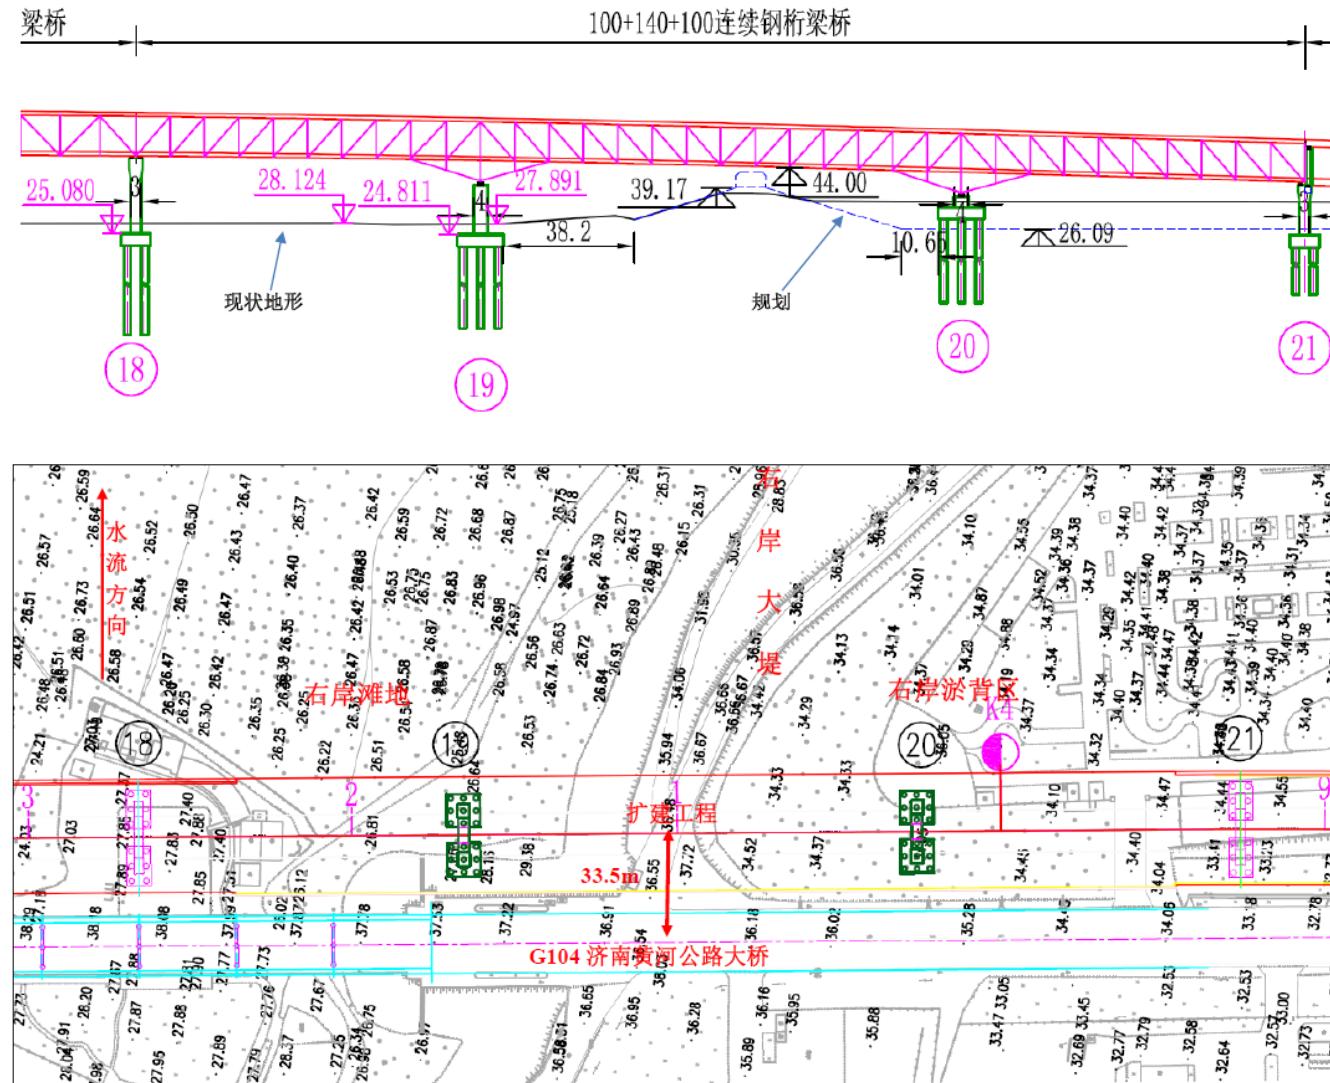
扩建工程桥梁跨右大堤方案平面图
